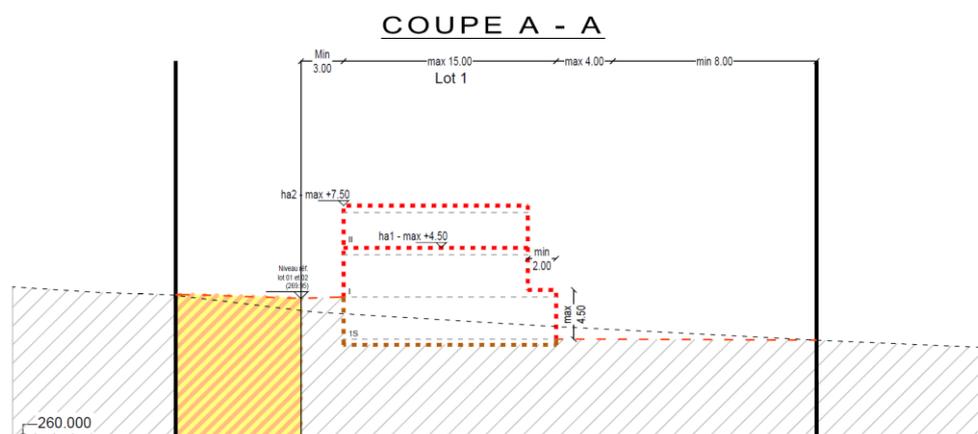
Coupe sur le lot n°1 (source : BEST).
